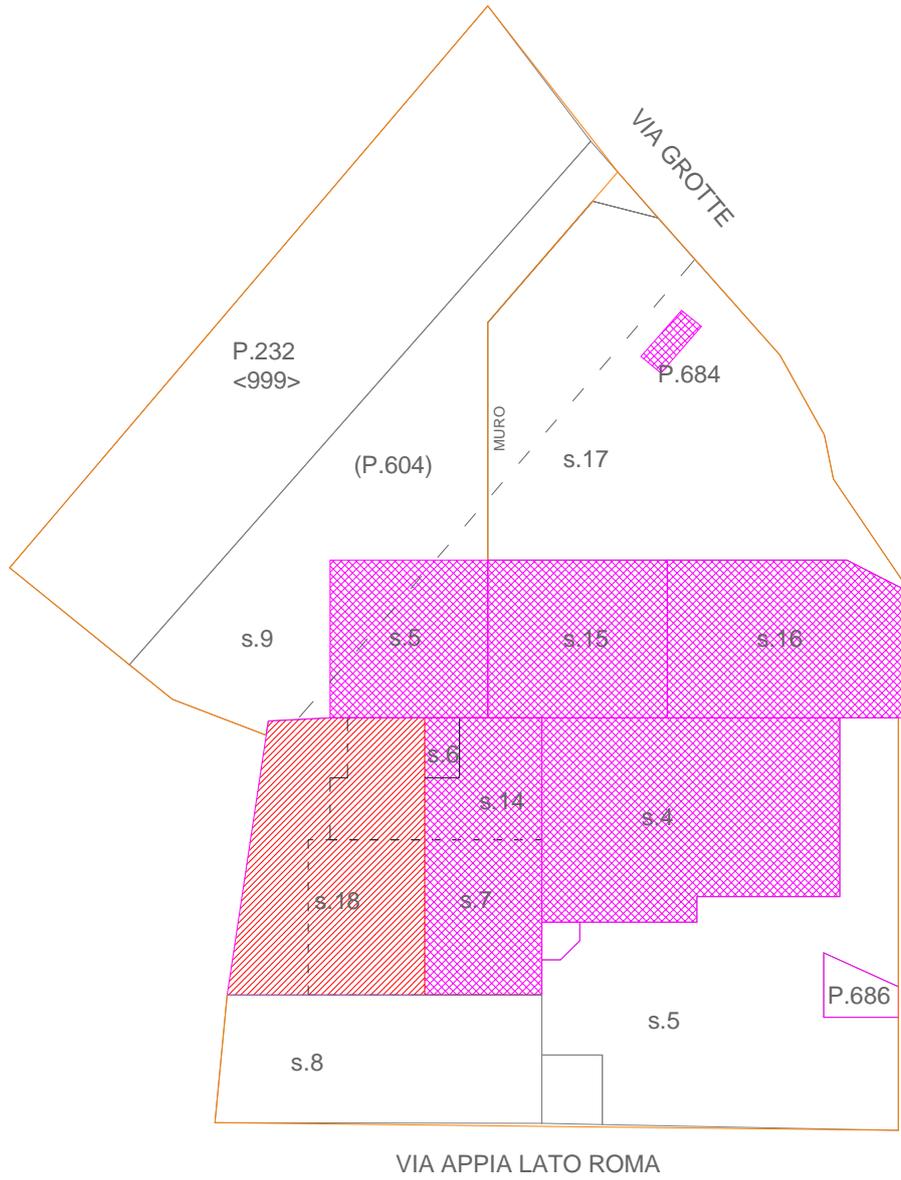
Planimetria dei diversi sub contenuti nel complesso industriale
